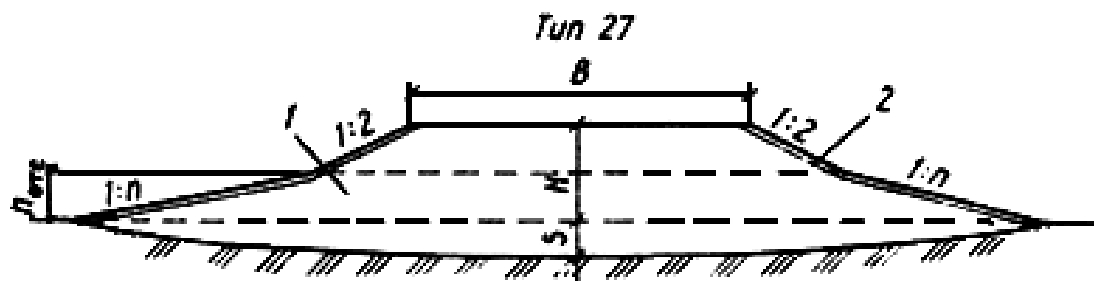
Поперечный профиль насыпи, возводимой способом гидромеханизации: 1 – гидронамытый песок; 2 – укрепление откоса
